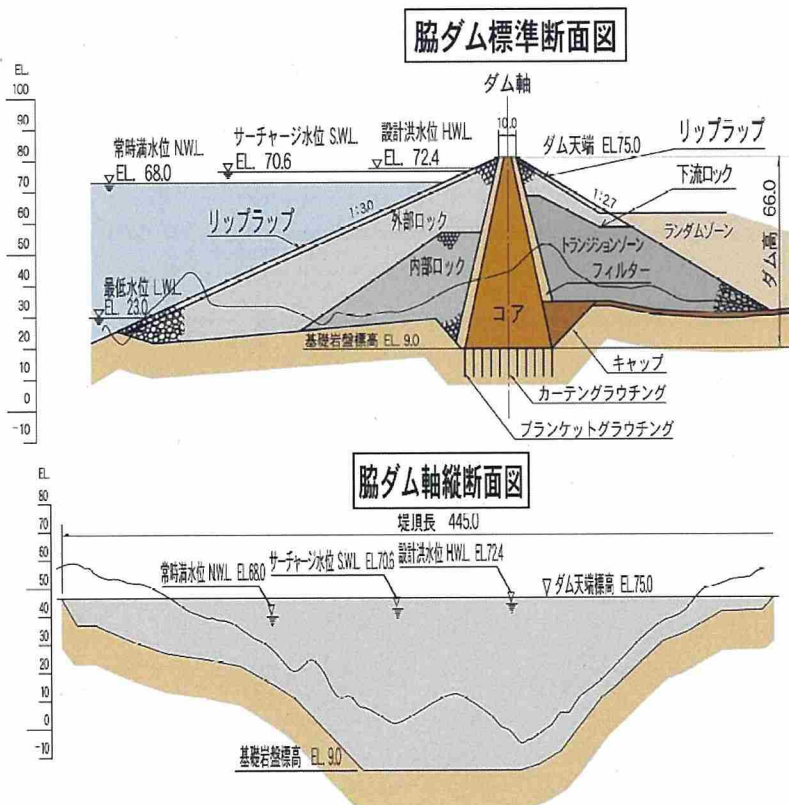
大保脇ダム 標準断面図・軸縦断面図
